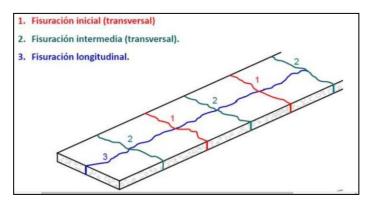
Desarrollo natural de fisuras de Pavimento Rígido
